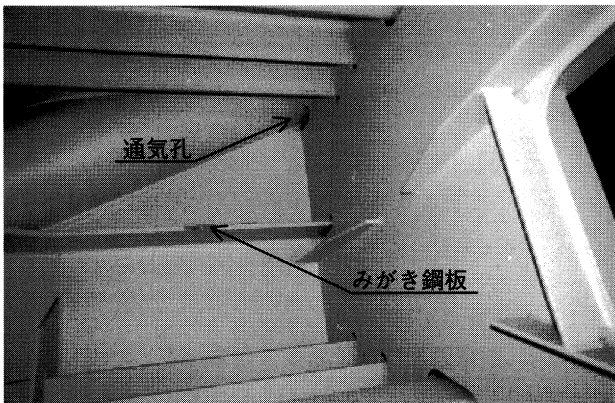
格点36 みがき鋼板設置状況 (通気孔近傍)
